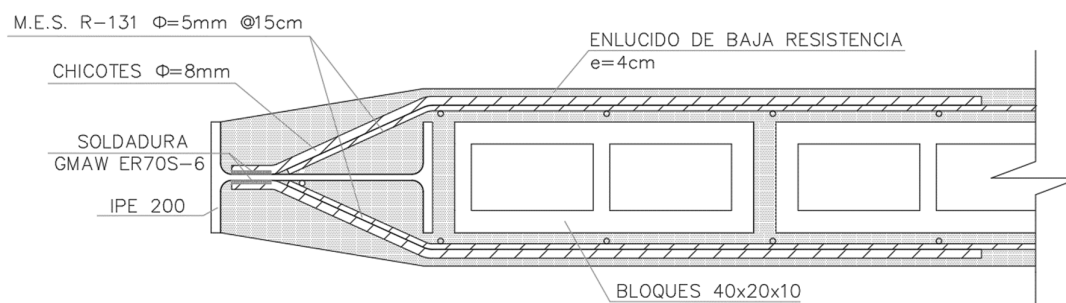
Geometría de elementos constituyentes de conexión entre enchape y pórticos de acero.
